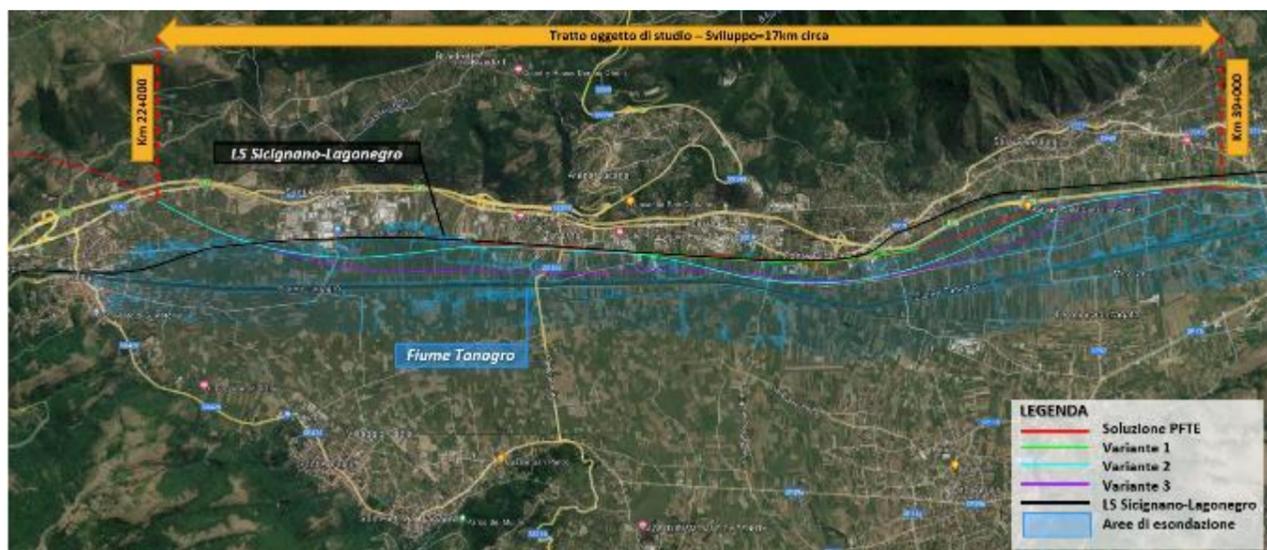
Stralcio corridoio B con individuazione delle tre soluzioni alternative
